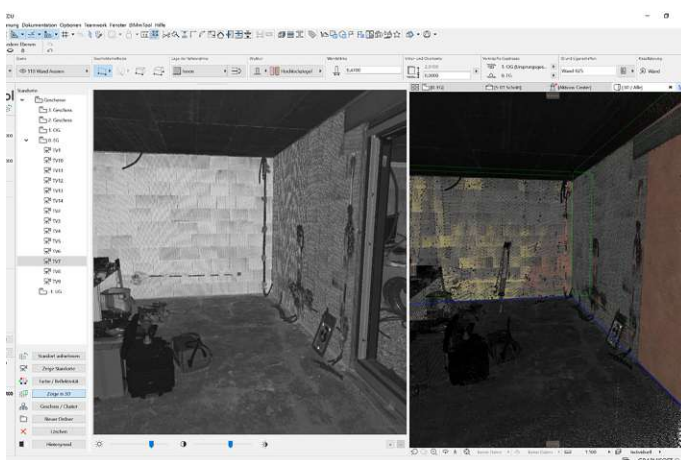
Modellierung der Außenwände mit Hilfe der Navigatoransicht (links) sowie die fertig modellierten Außenwände im Grundriss (rechts)
